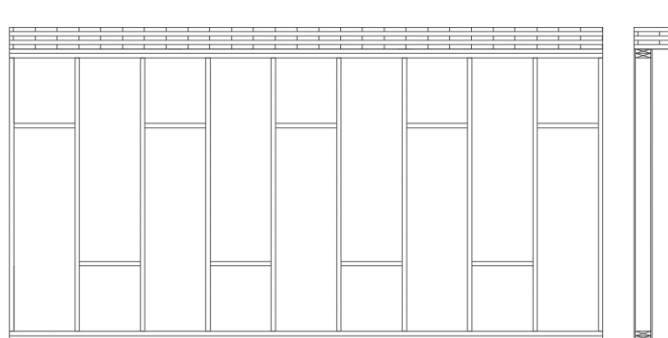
CLT apoiado diretamente sobre a parede em *timber-frame
